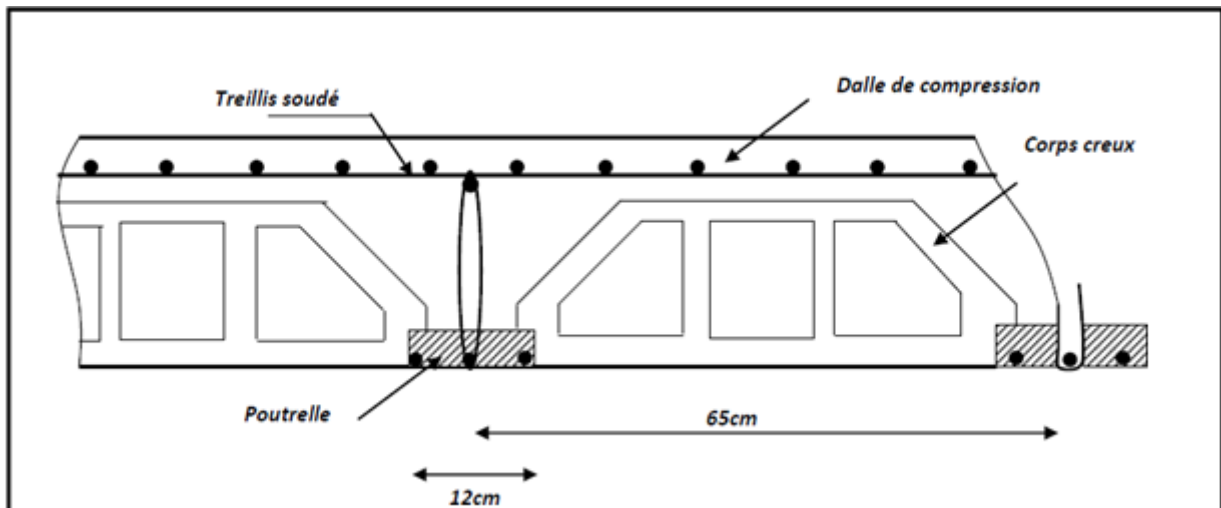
Coupe verticale d'un plancher à corps creux en polystyrène.
